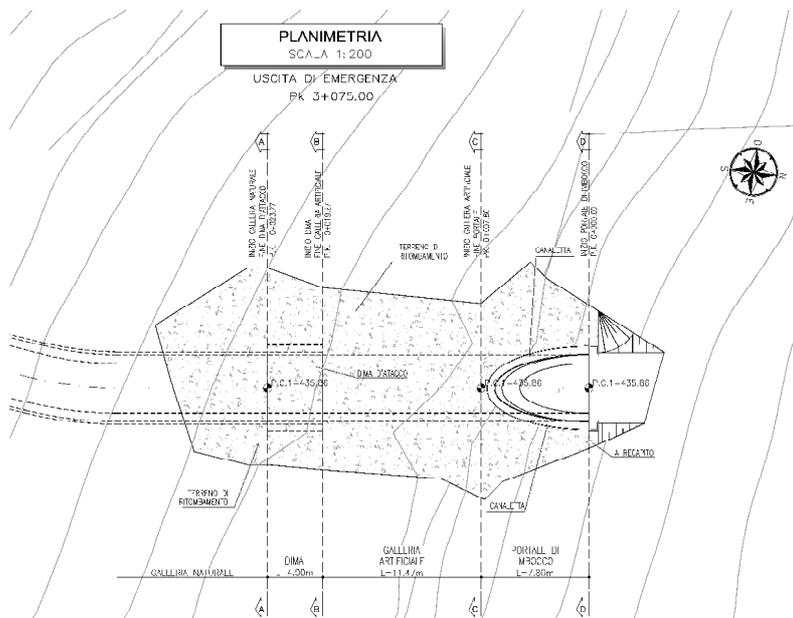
Planimetria Definitiva Uscita/Accesso Giave.
